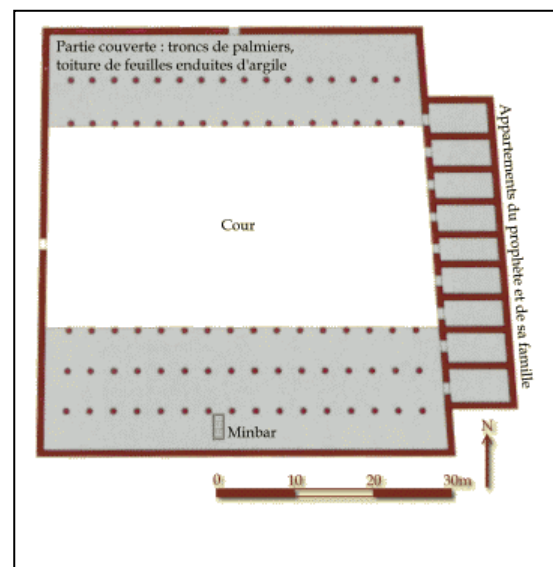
plan restitué de la salle de prière construite dans la maison du prophète à Médine Source (Stierlin, 1979, p24)
